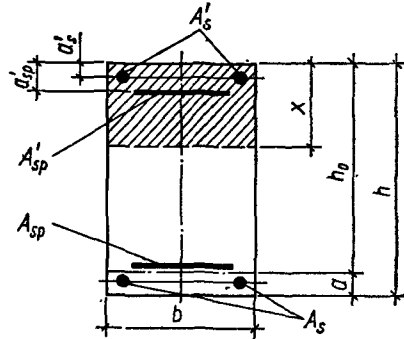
Поперечное прямоугольное сечение изгибаемого железобетонного элемента.
